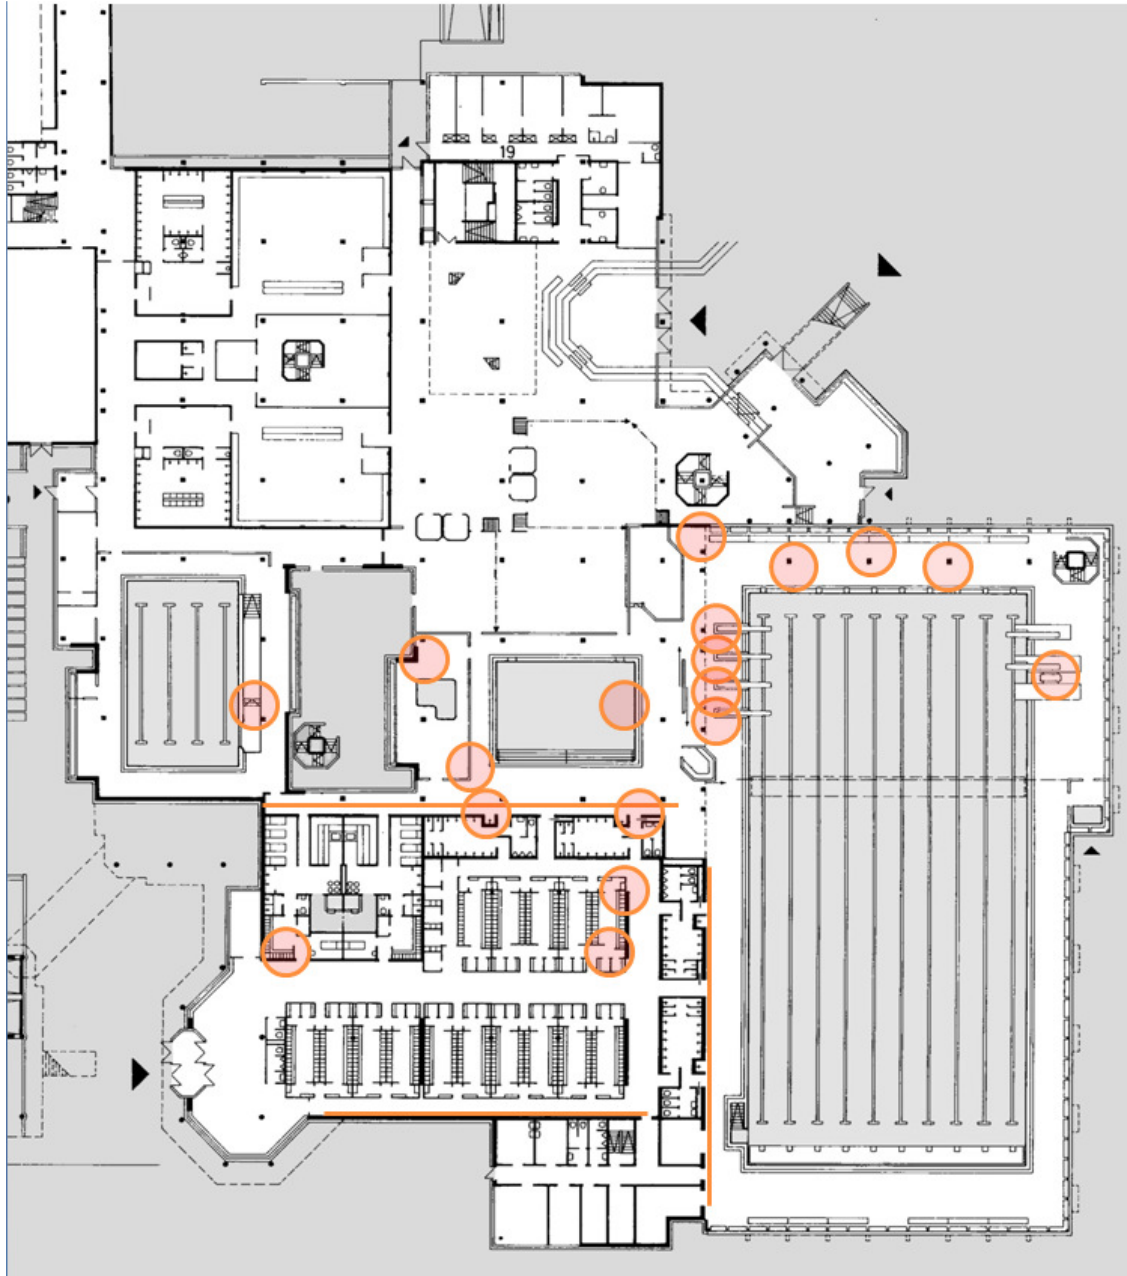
Übersicht Betrachtungsschwerpunkte "Beton" in der Badeebene
